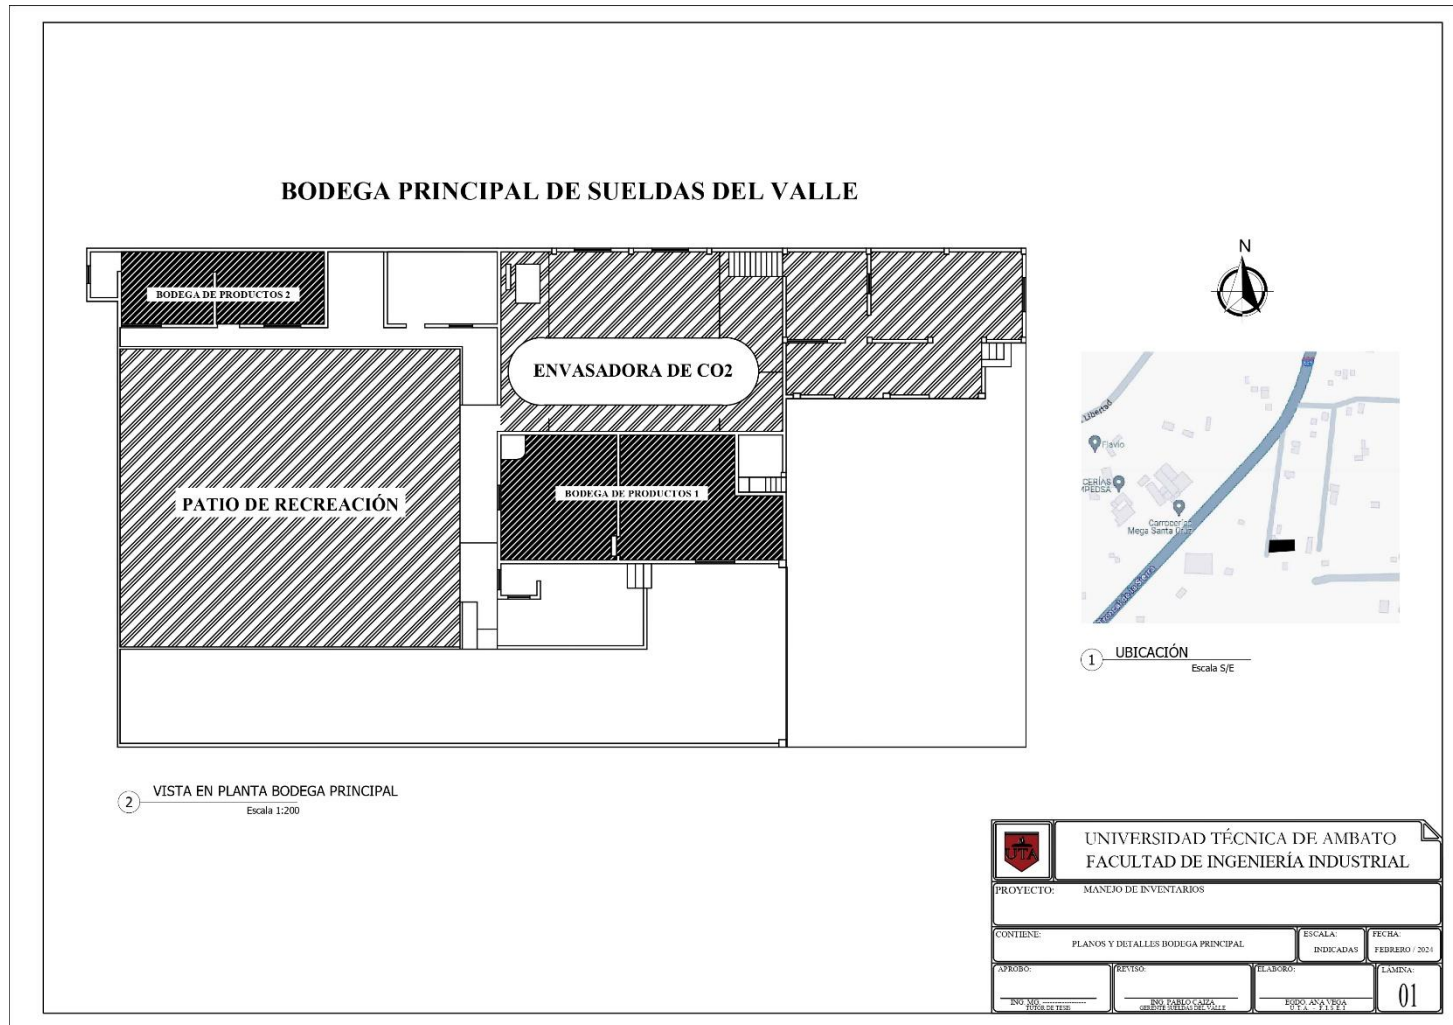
Layout de la bodega de la empresa Suedas del Valle.
